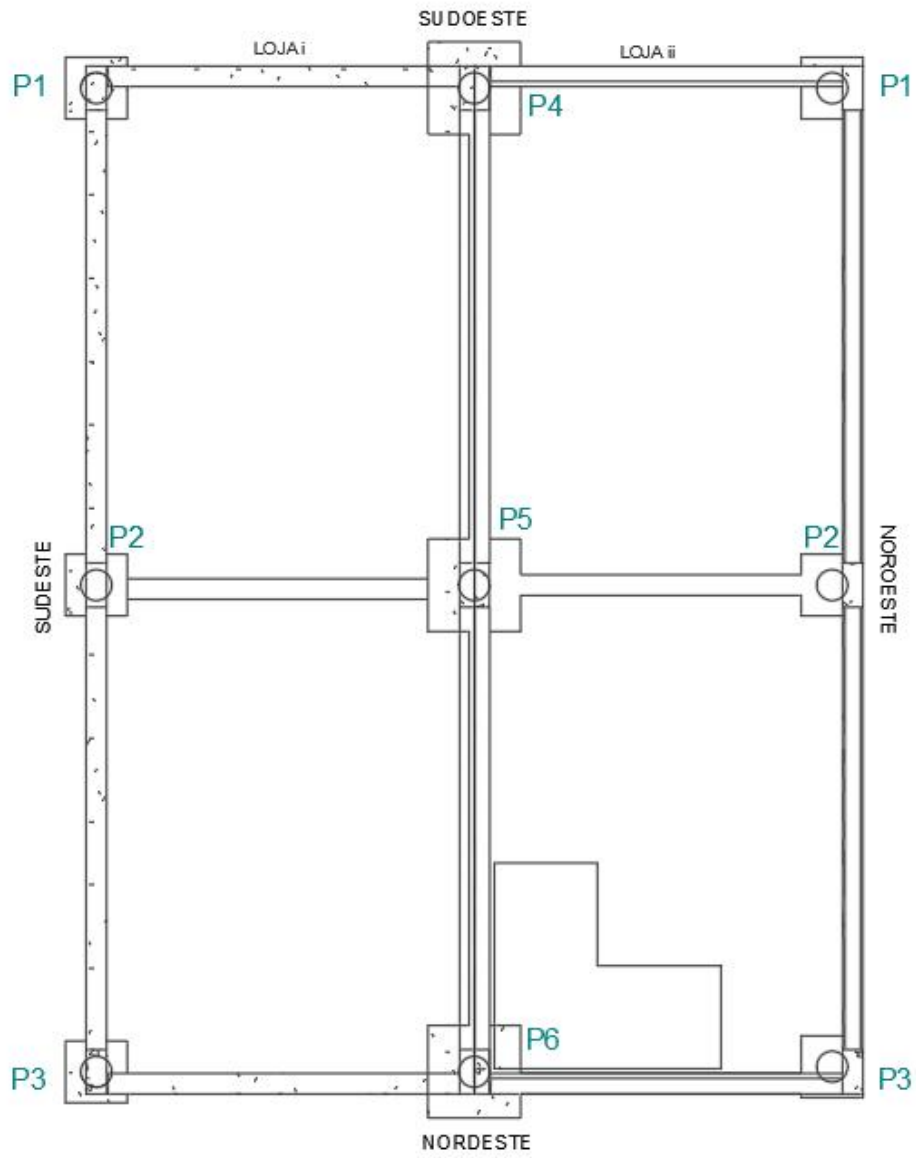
Planta de fôrma com nomeação dos pilares - nível 100 (1º pavimento).
